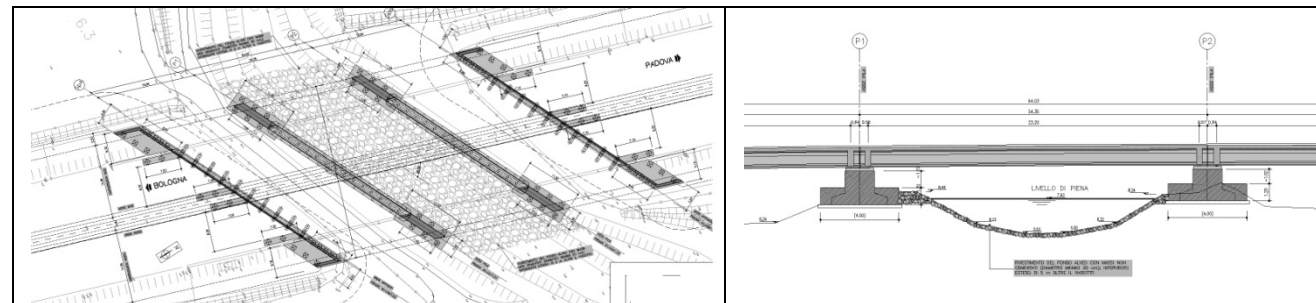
Canale Bisatto planimetria e sezione longitudinale
